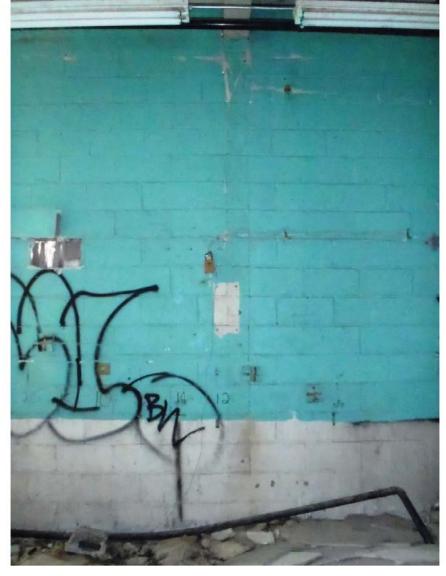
Fissuration typique des blocs des murs extérieurs vis-à-vis les poteaux d'acier qui y sont insérés
